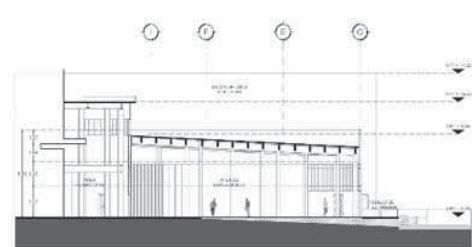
Sección estructura edificio B, área de exposiciones. Elaboración propia.
